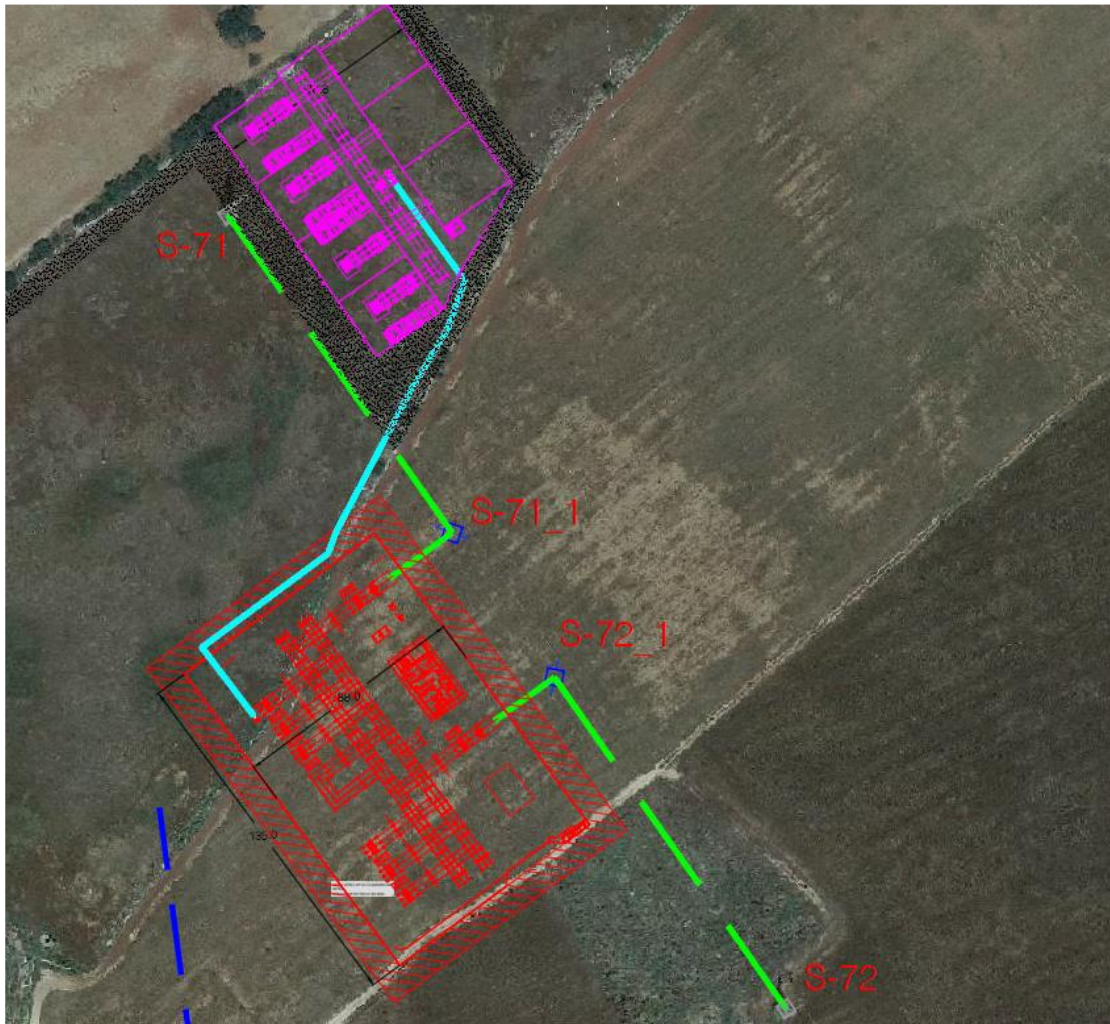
Planimetria nuovi raccordi aerei su base ortofoto
